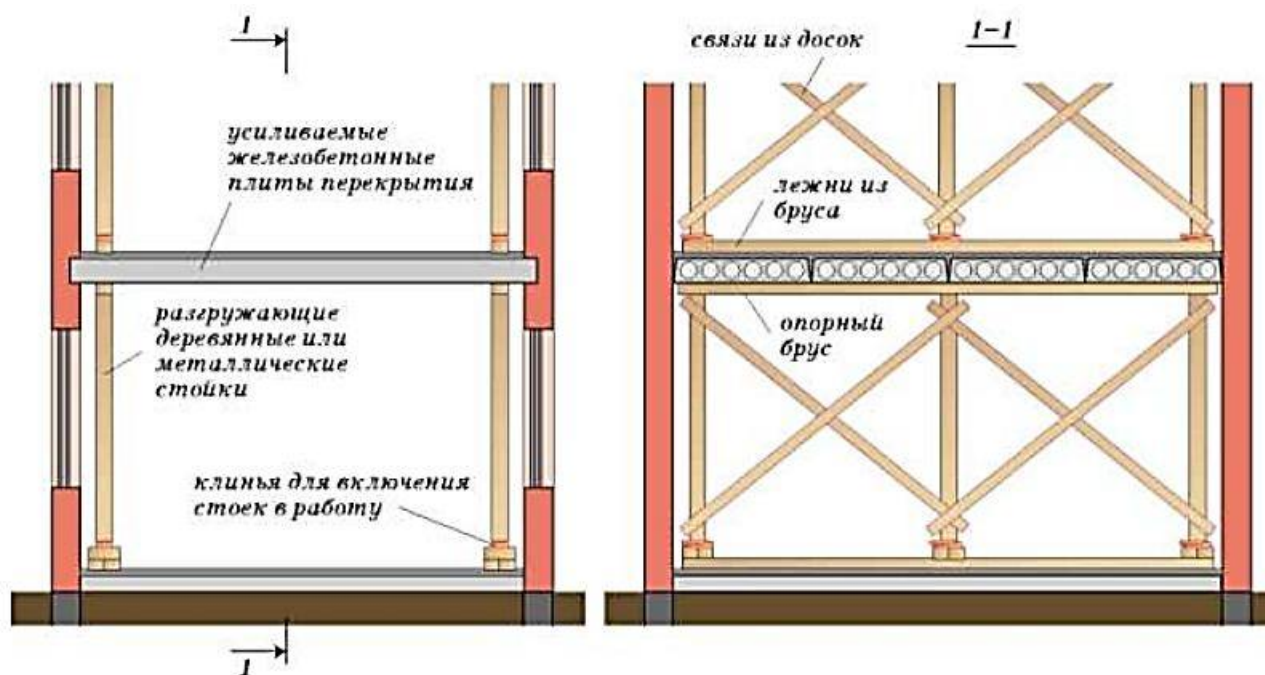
Подведение стоек вблизи опор для временного усиления плит перекрытия
